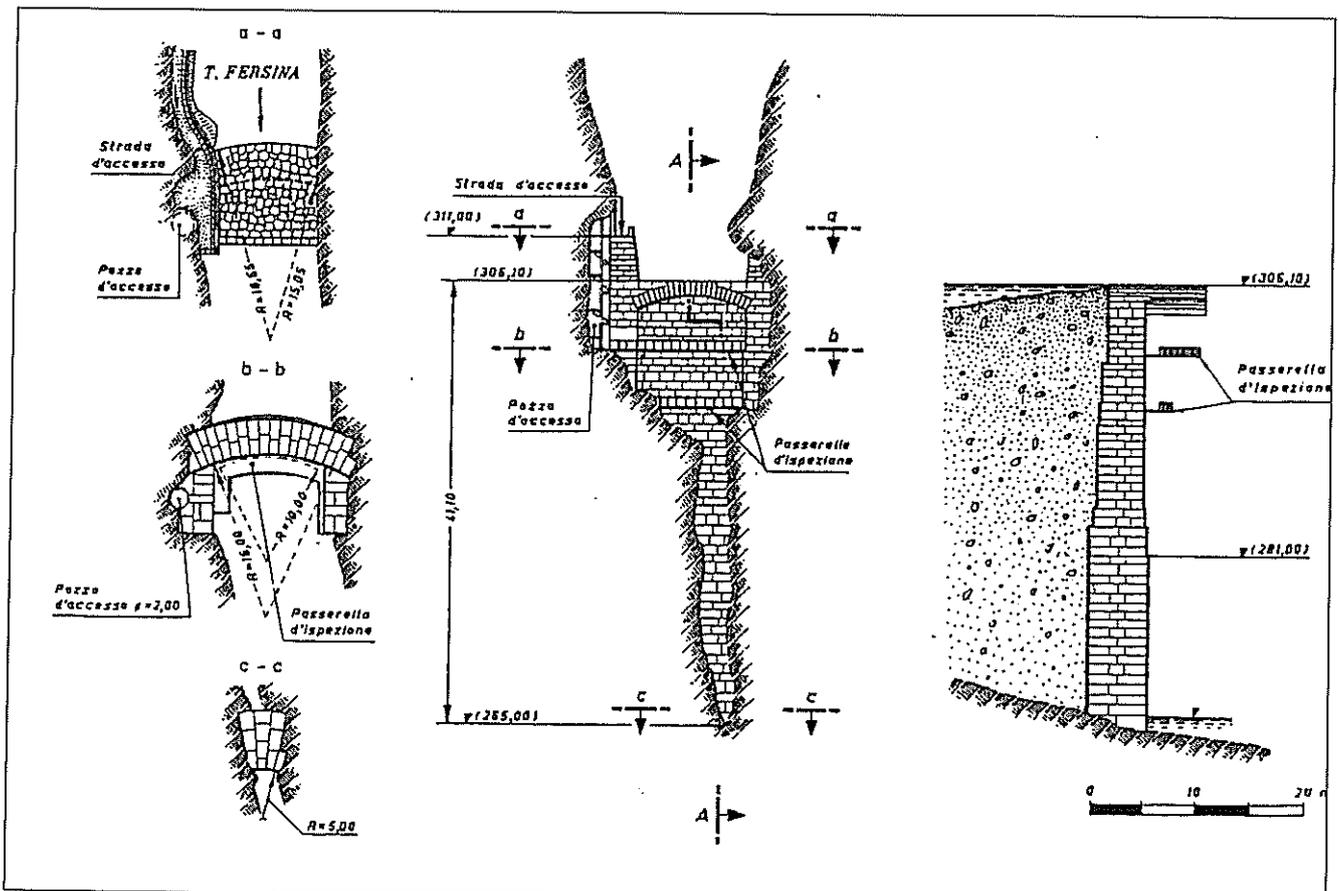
Diga di Madruzzo: Vista da valle - Sezione tipo - Sezioni orizzontali.
